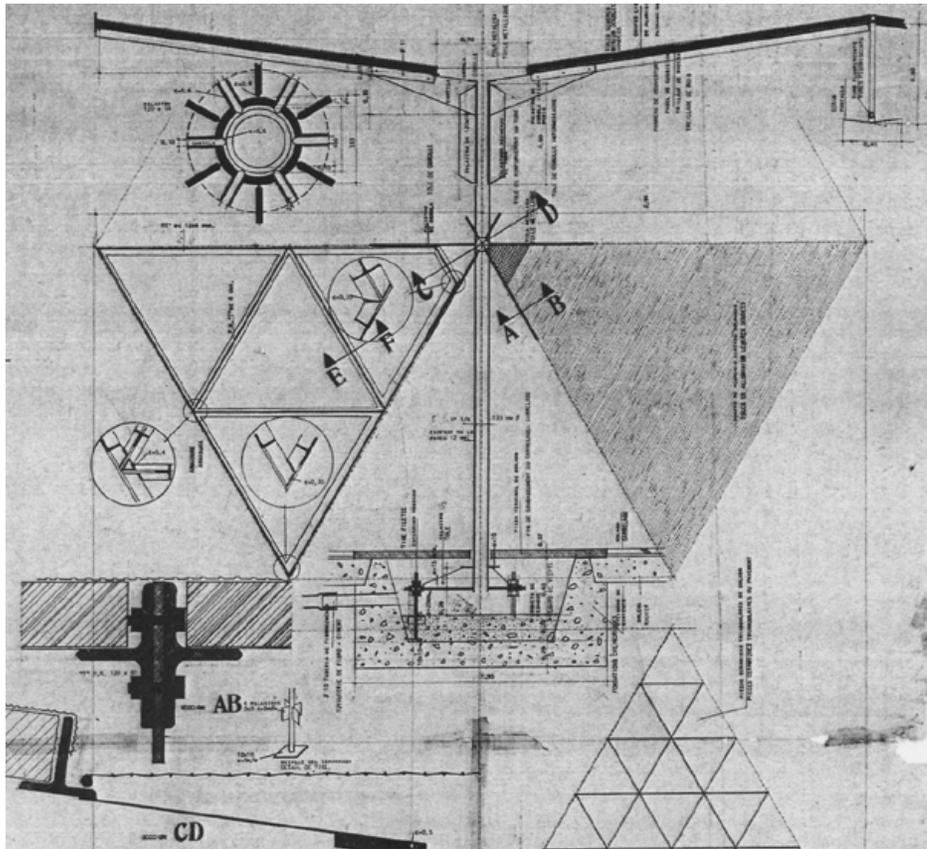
Dibujo con los detalles originales del pilar para su ejecución en obra, 1958.
